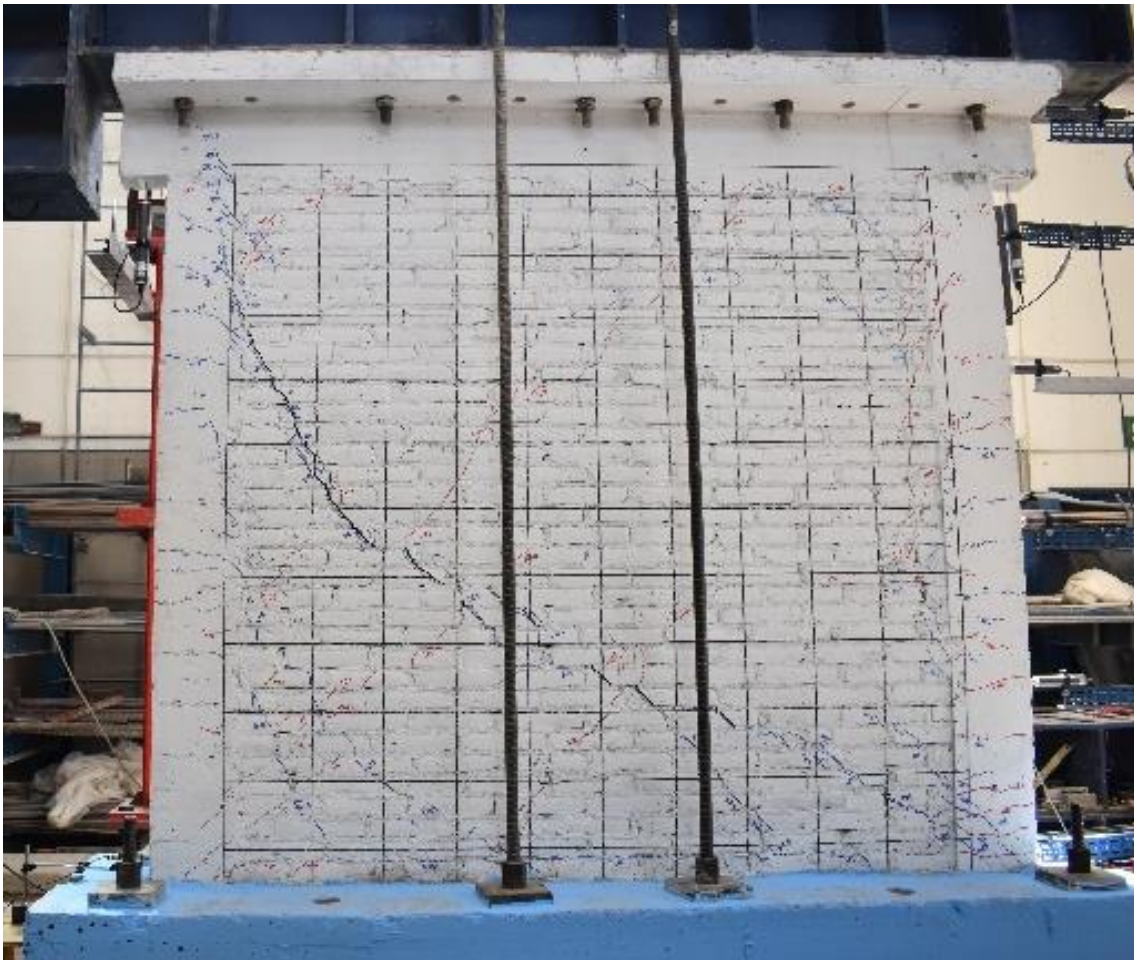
Grieta diagonal al final de la prueba del muro 1.
